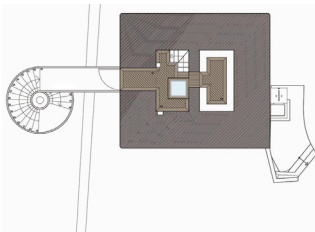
94. Planos plantas 0 - 3. (web: arquitecturazonazero)
